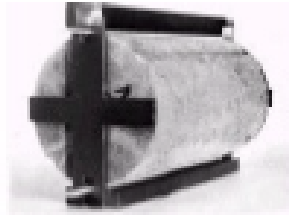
Guías para alinear los cilindros de hormigón y las franjas de apoyo
